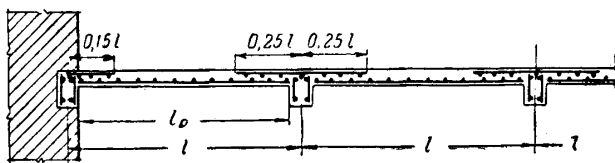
Раздельное армирование плит сварными рулонными сетками с поперечным расположением рабочих стержней
